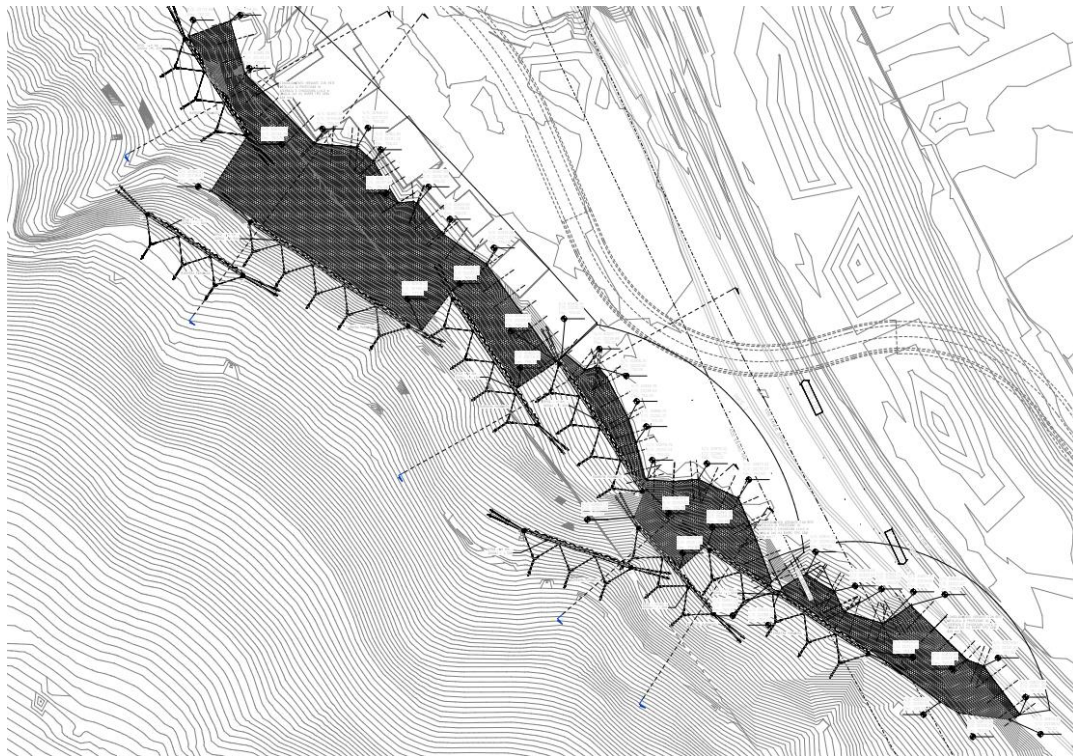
Imbocco Nord Scaleres – Barriere paramassi e reti di protezione del versante - localizzazione degli interventi
